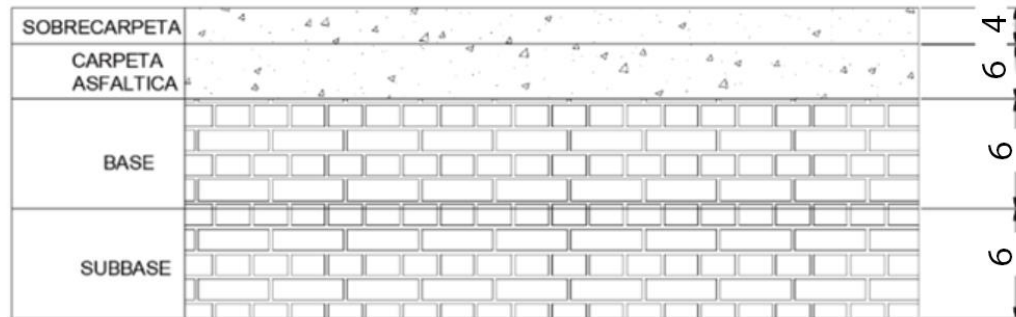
Diseño para pavimentación en Puentes Las Morochas y Valle de oro Norte
